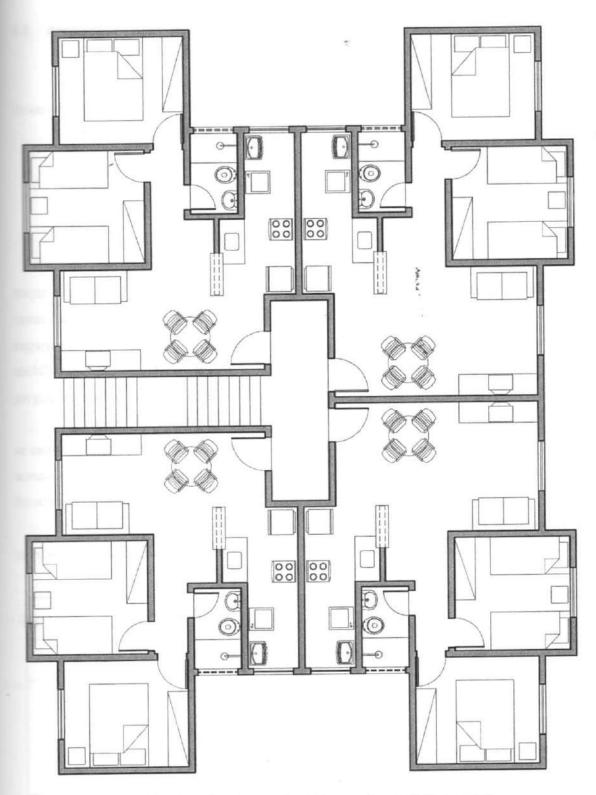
Planta do pavimento tipo do Empreendimento C. (Fonte: autor)
